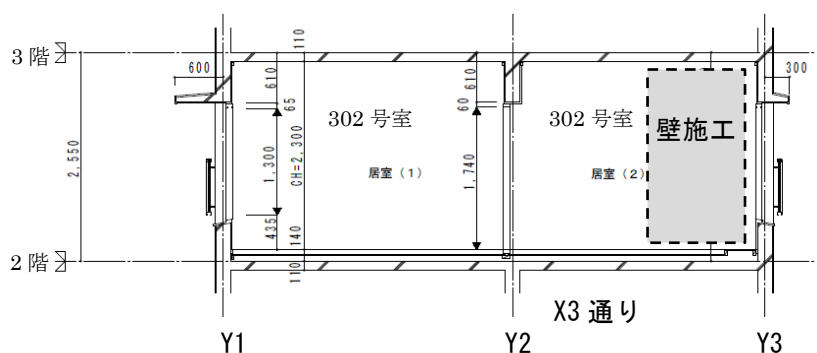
壁のアンカー施工位置 (断面図)
